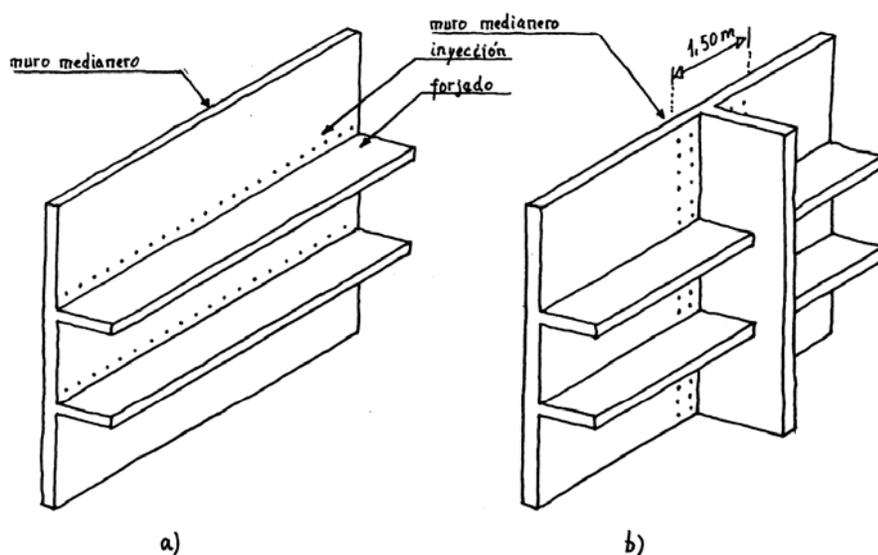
Tratamiento de muros medianeros: a) Barreras horizontales al nivel de los forjados y b) Barreras verticales a lo largo de la intersección con los muros transversales.
